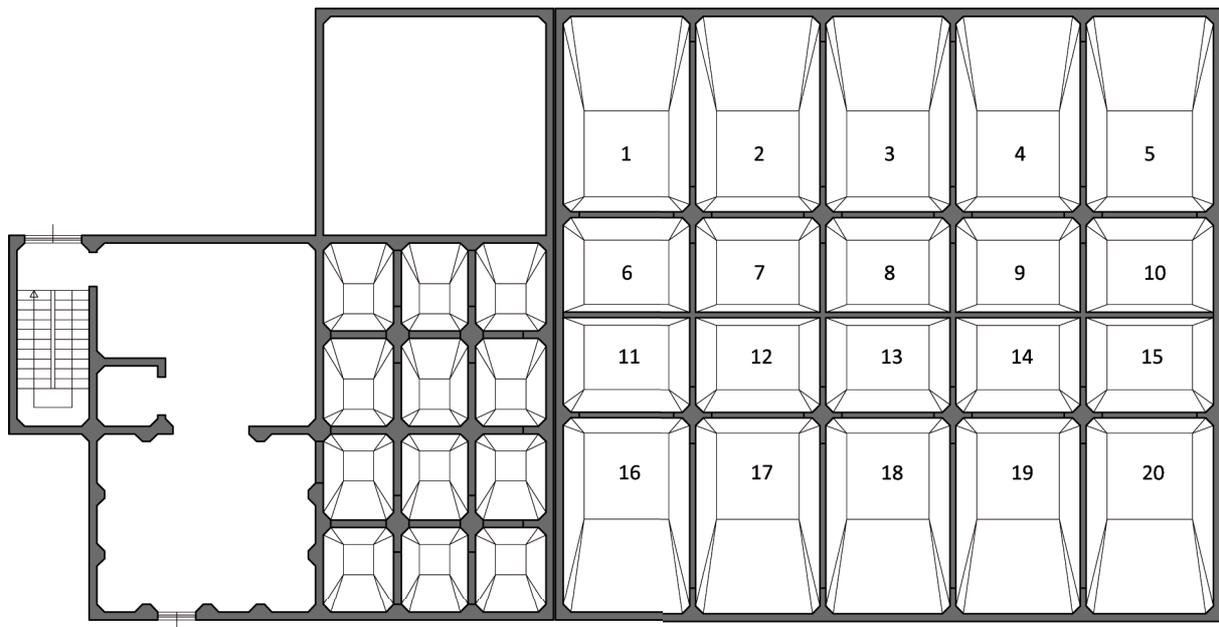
Bestandsplan - Grundriss 6. OG
